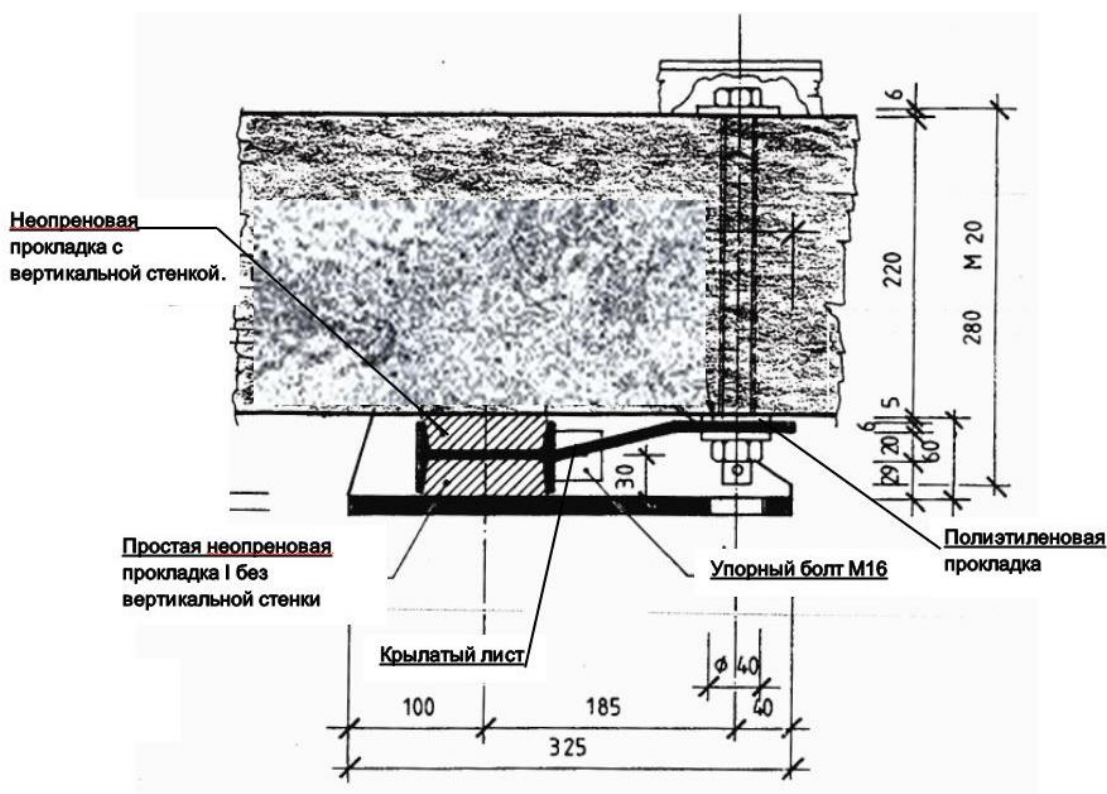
Поперечный вид опирания на продольную балку железобетонного бруса.
